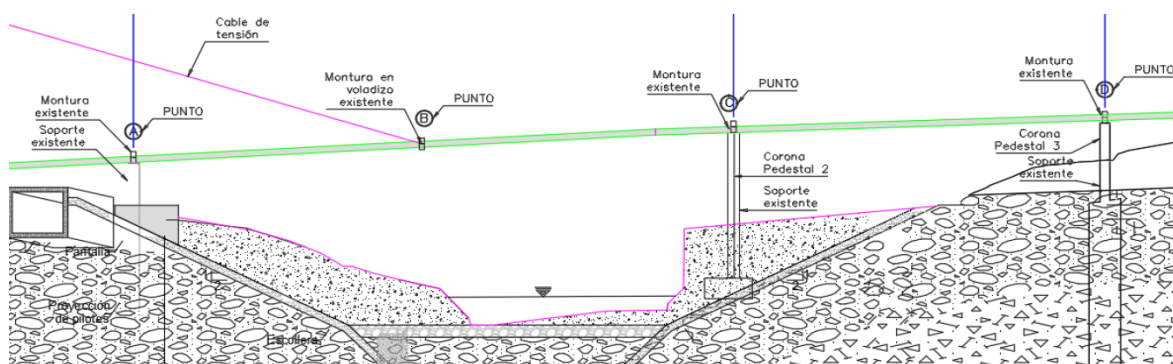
Situación de la tubería previa a la intervención. Plan de construcción MECO.
